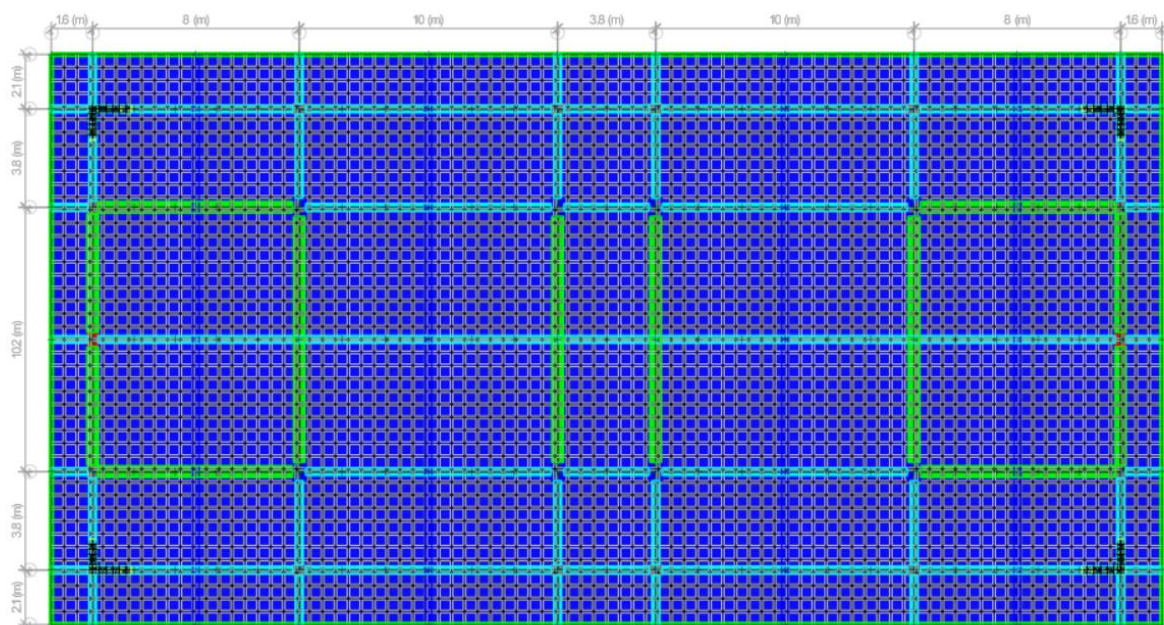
Vista en planta del piso alto de la edificación.
